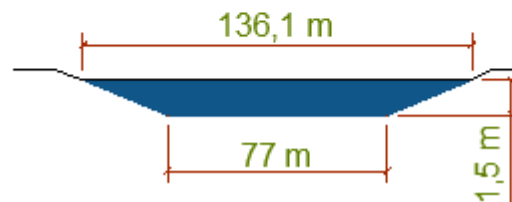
Detalhes da planta baixa e seção longitudinal das lagoas de maturação
